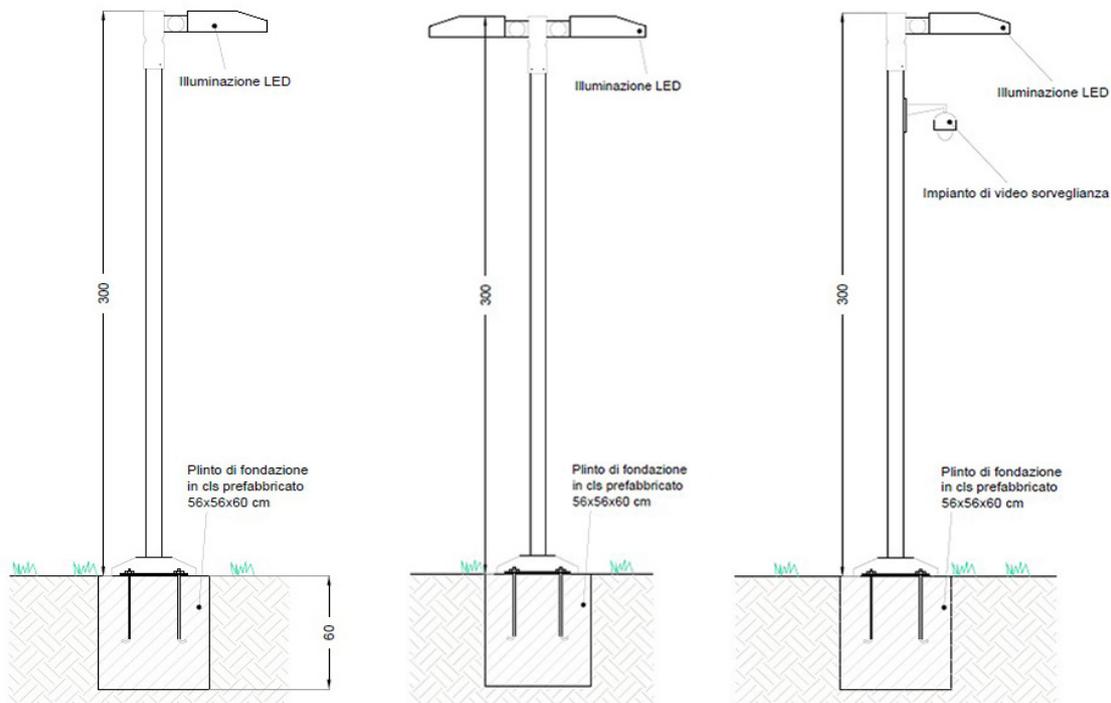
Dettaglio tipico di integrazione tra illuminazione e sistema di videosorveglianza dell'impianto – tutte le misure in cm
